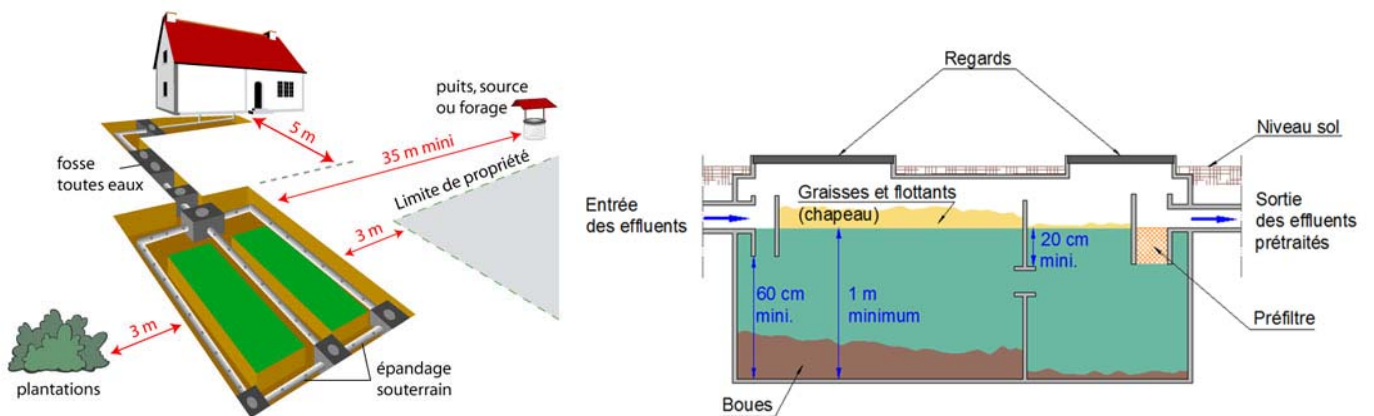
MAISON EQUIPEE D'UNE FOSSE TOUTES EAUX ET D'UN SYSTEME D'EPANDAGE (A GAUCHE) ET VUE EN COUPE D'UNE FOSSE TOUTES EAUX (A DROITE)
